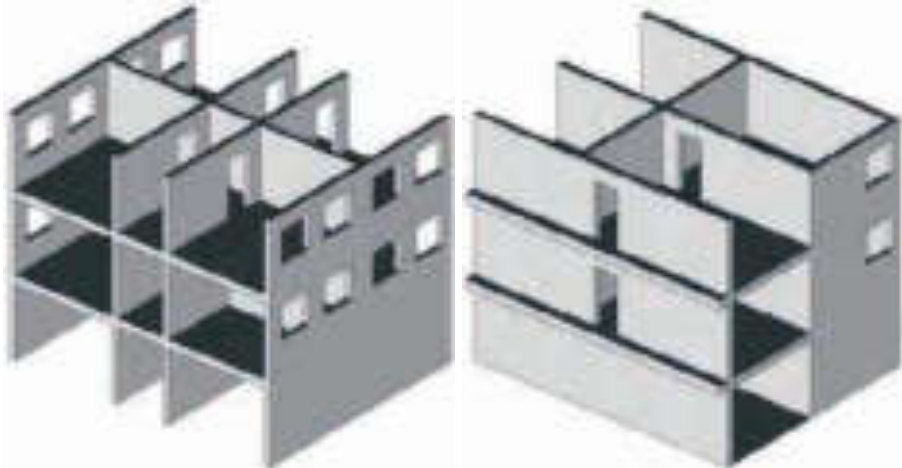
A sinistra struttura a pareti portanti longitudinali; a destra strutture a pareti portanti trasversali.
